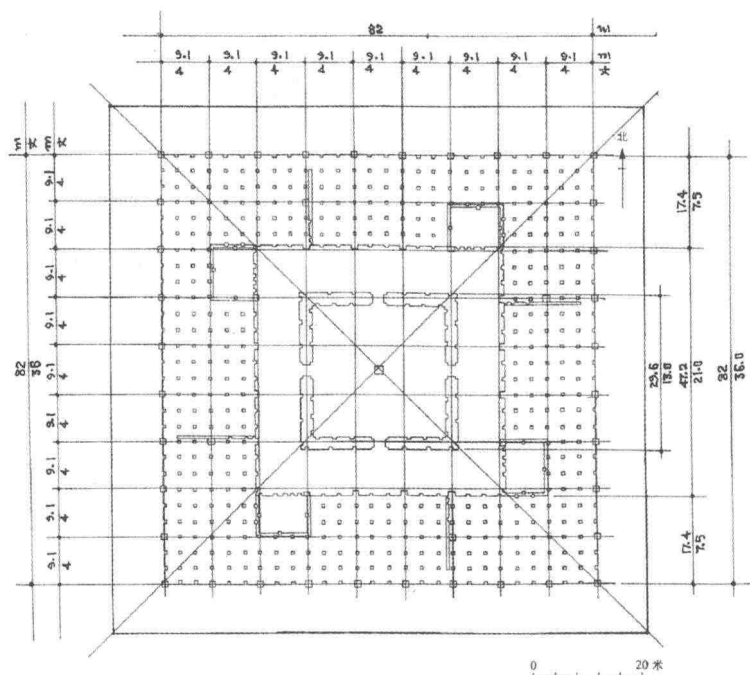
西安王莽宗庙第12号遗址中心建筑平面图
